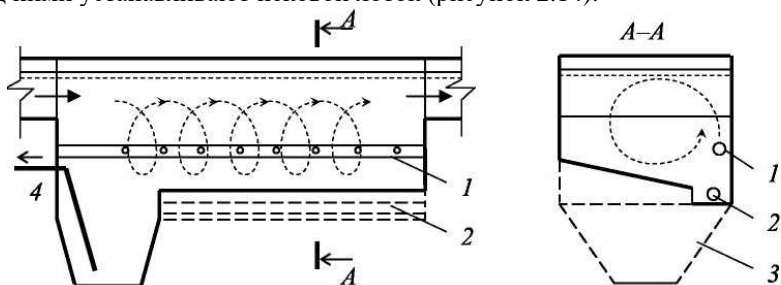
Схема аэрируемой песколовки с гидромеханической системой удаления осадка [10]:
